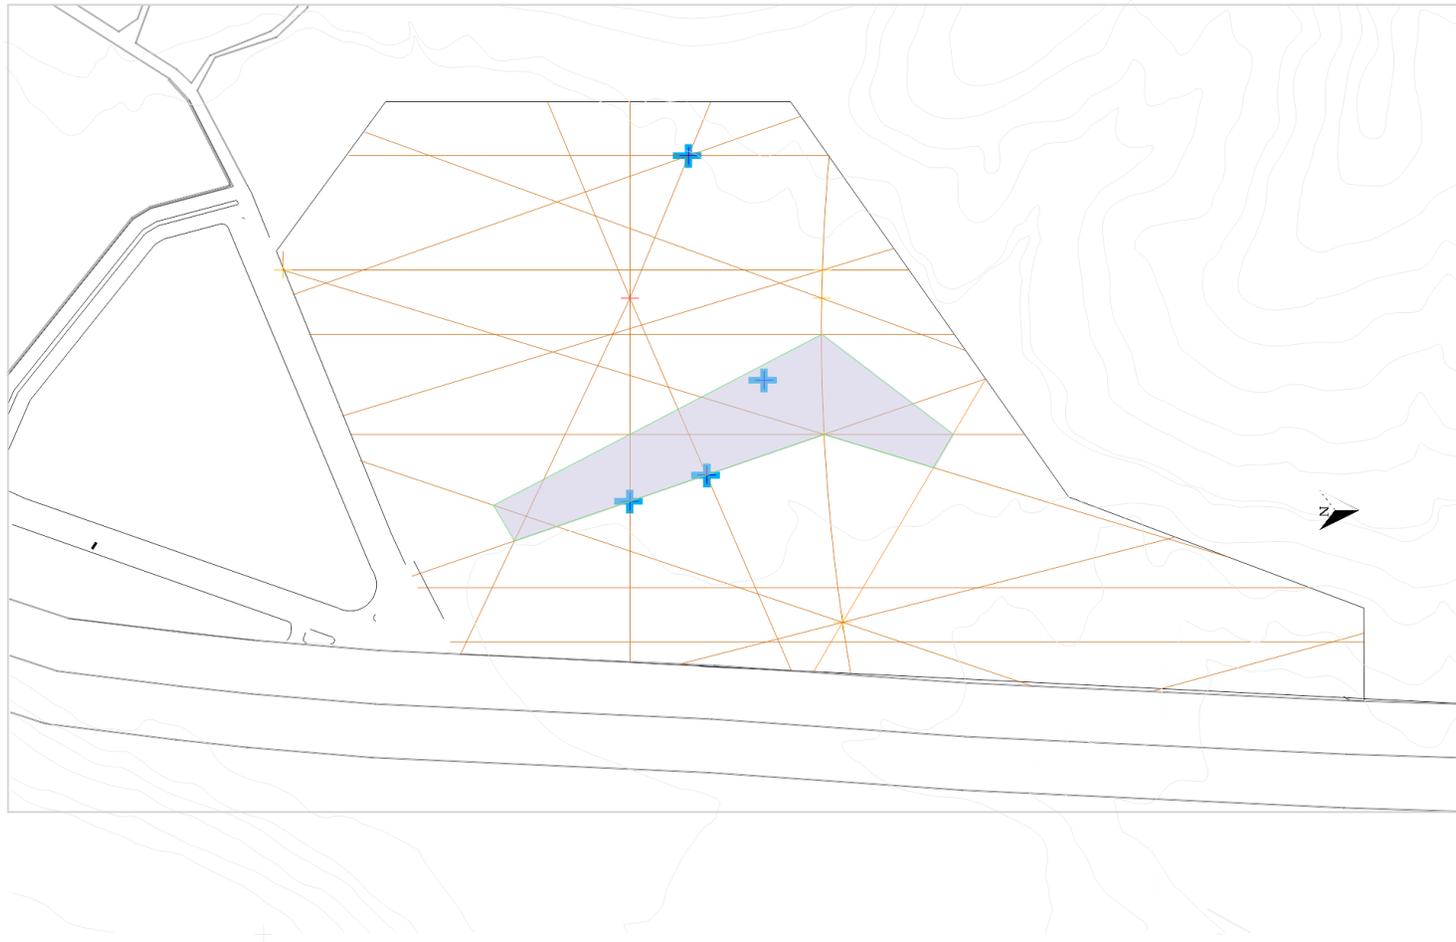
Ubicación del proyecto arquitectónico con base a las proyecciones realizadas en el lugar de implantación
